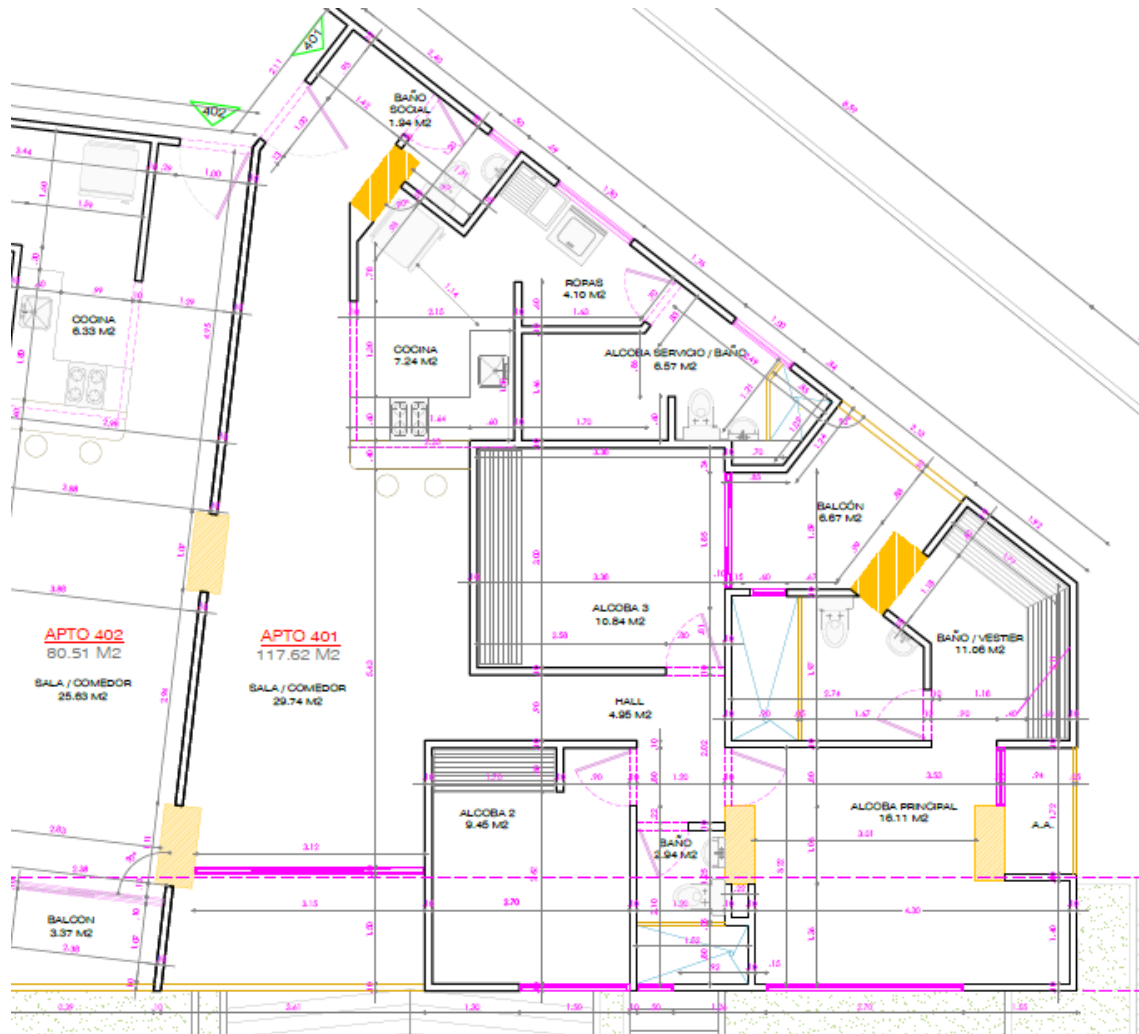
Planta Arquitectónica apartamento tipo 1B (Pedrozo Perez)
